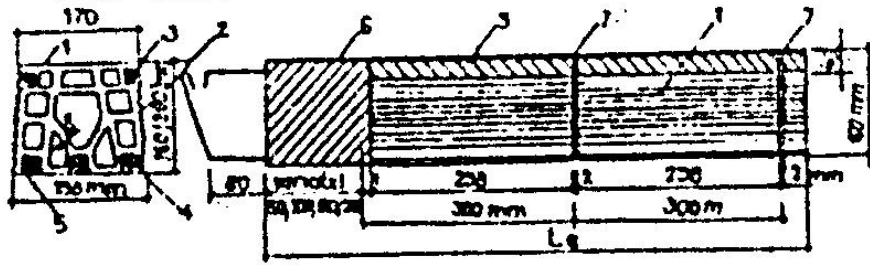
Decken aus Keramikkörper und Stahlbetonrippen
